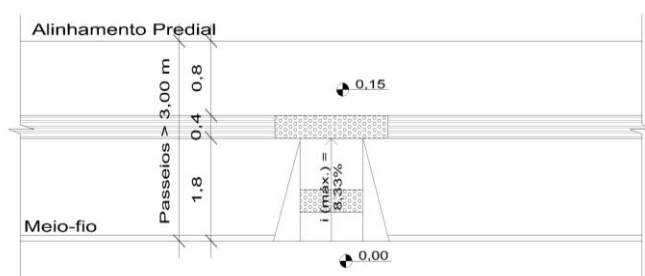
Rebaixos em passeios com largura maior que 3 m (três metros).
